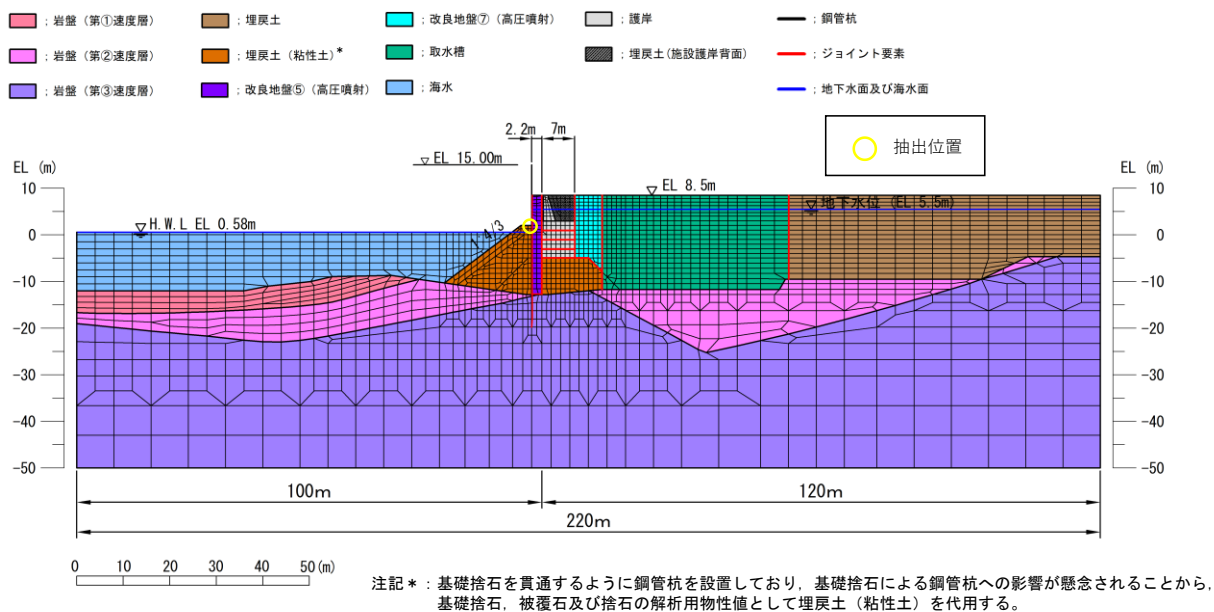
(3) 鋼管杭変位の抽出位置 (④-④断面)
